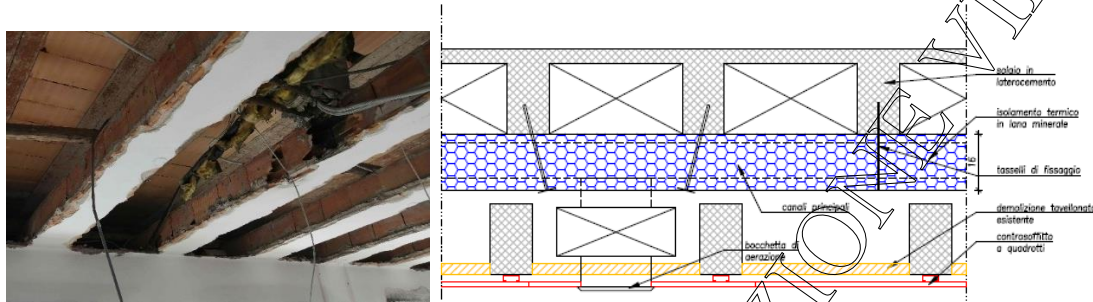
Demolizione del tavellonato, isolamento termico e nuovo controsoffitto
